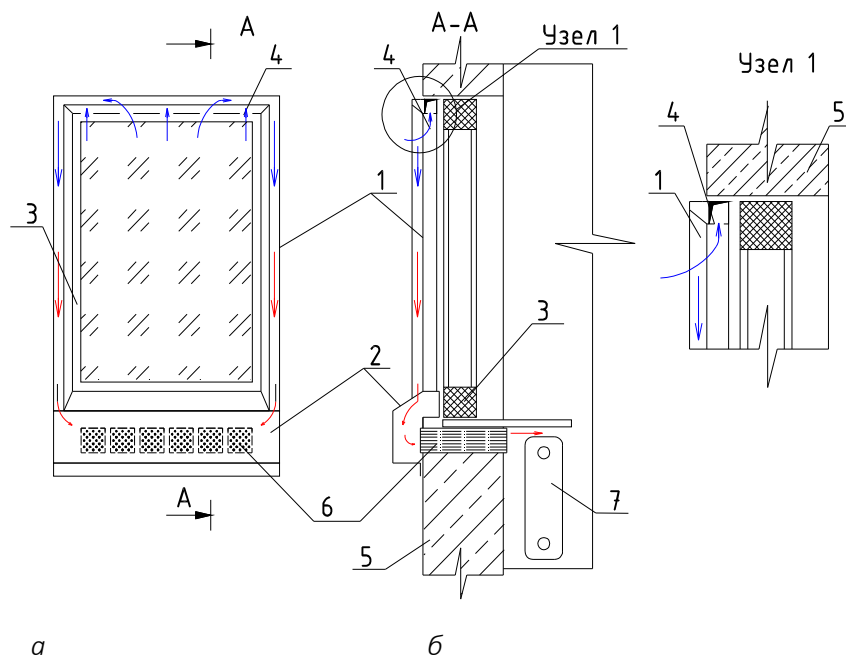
Схема установки инсолятора на наружной стене здания:
